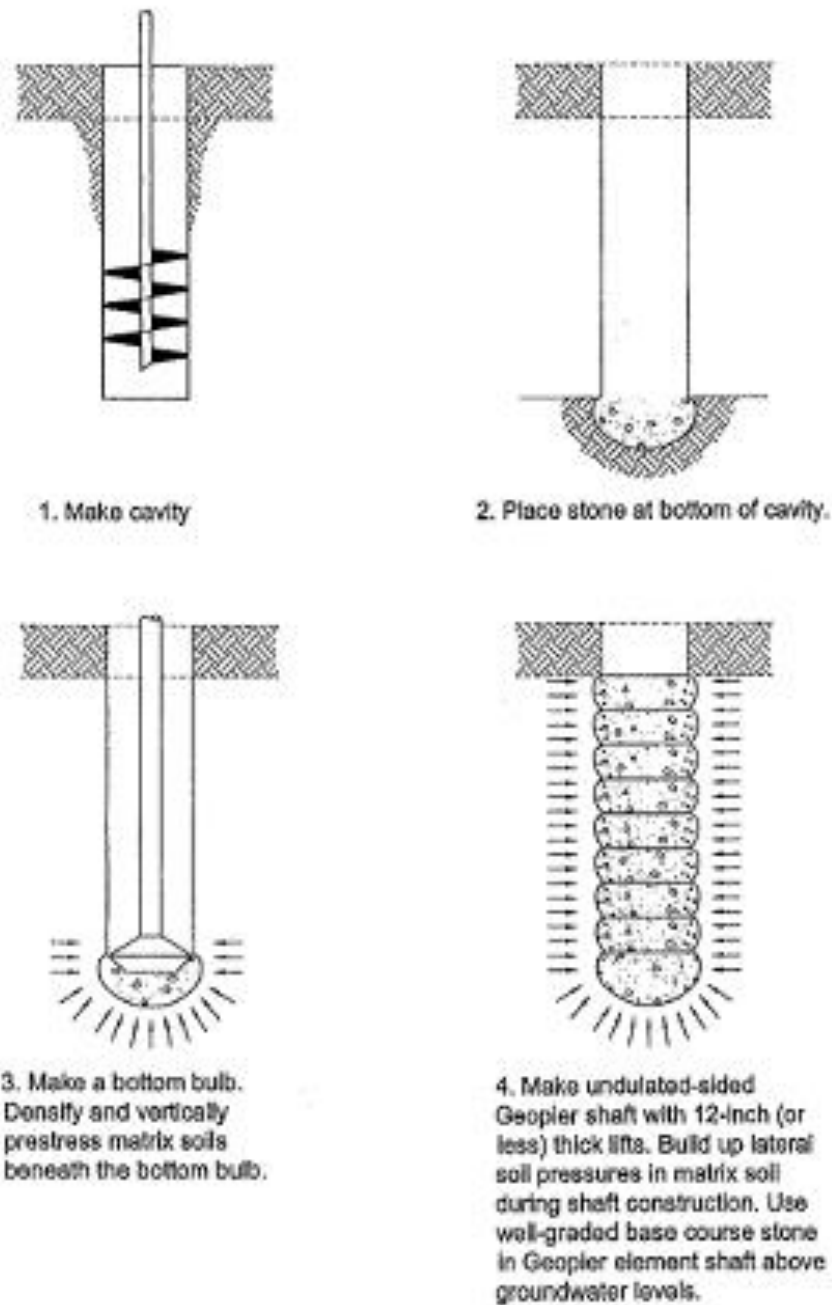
Proceso de construcción típico de una pila de agregado compactado, Adaptado de "GEOPIER foundation And Soil reinforcement manual" por Fox and Comwell (1998).
